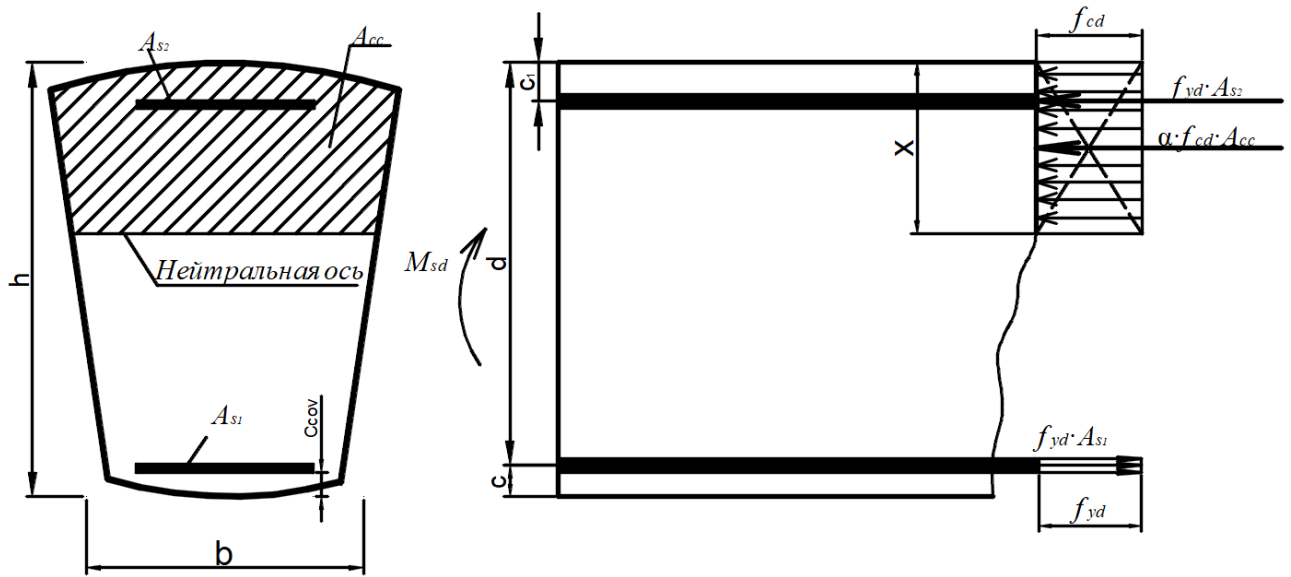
Расчетное предельное состояние произвольного сечения с двойной арматурой
